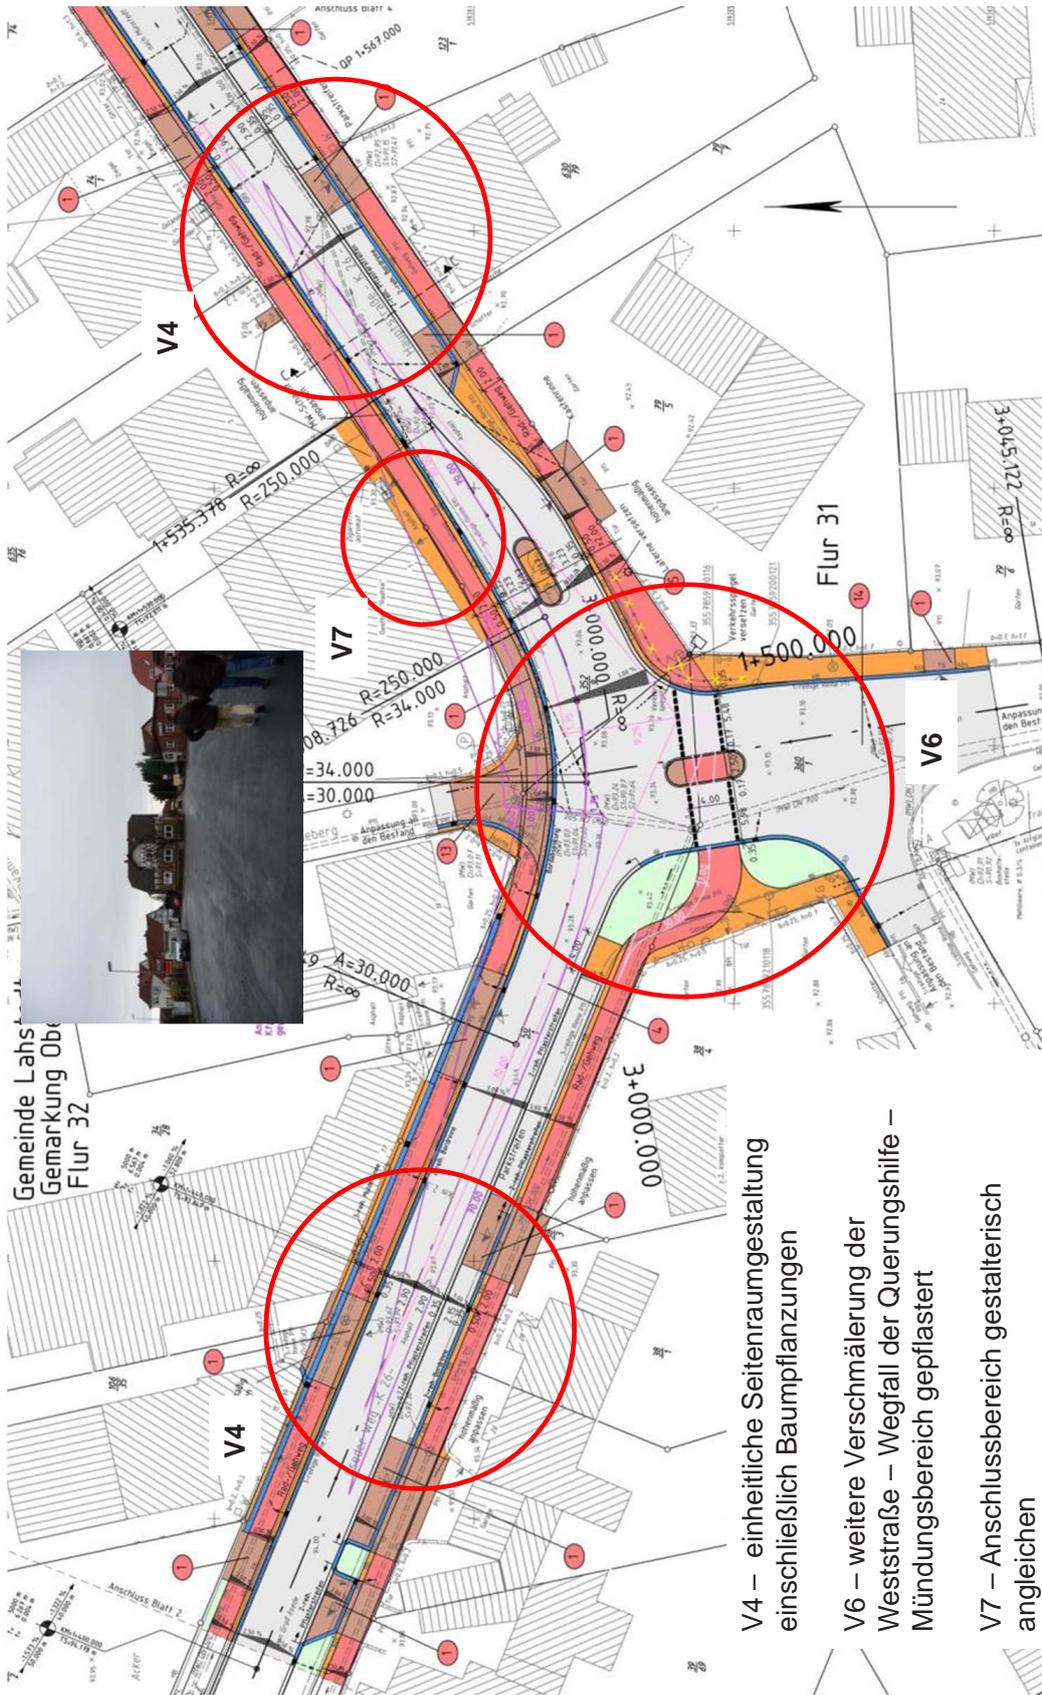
Umgestaltungsvorschläge zur Ortsdurchfahrt Oberg - Lageplan Blatt 1
